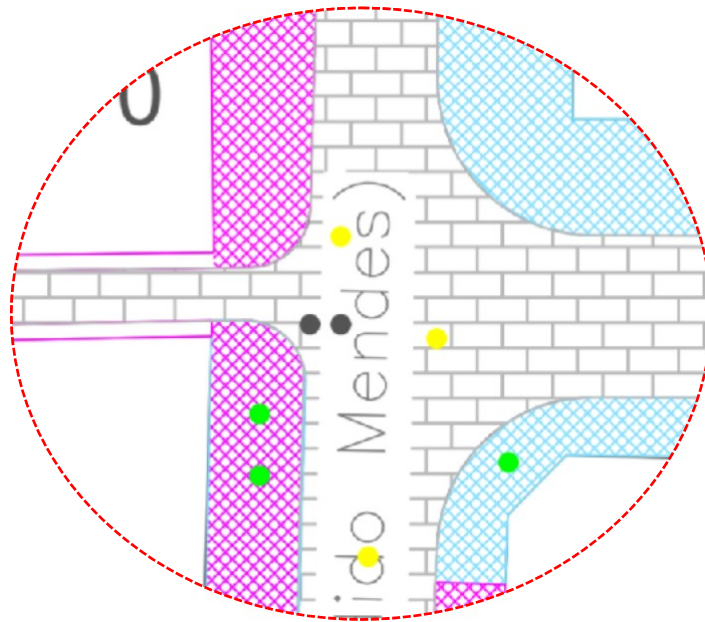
Mesmo trecho para levantamento cadastral no AutoCAD
